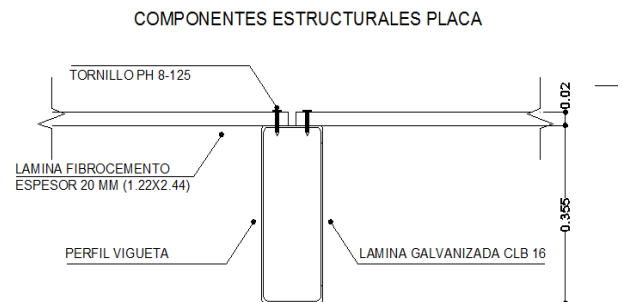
Componentes estructurales sistema de losa liviano en seco.
